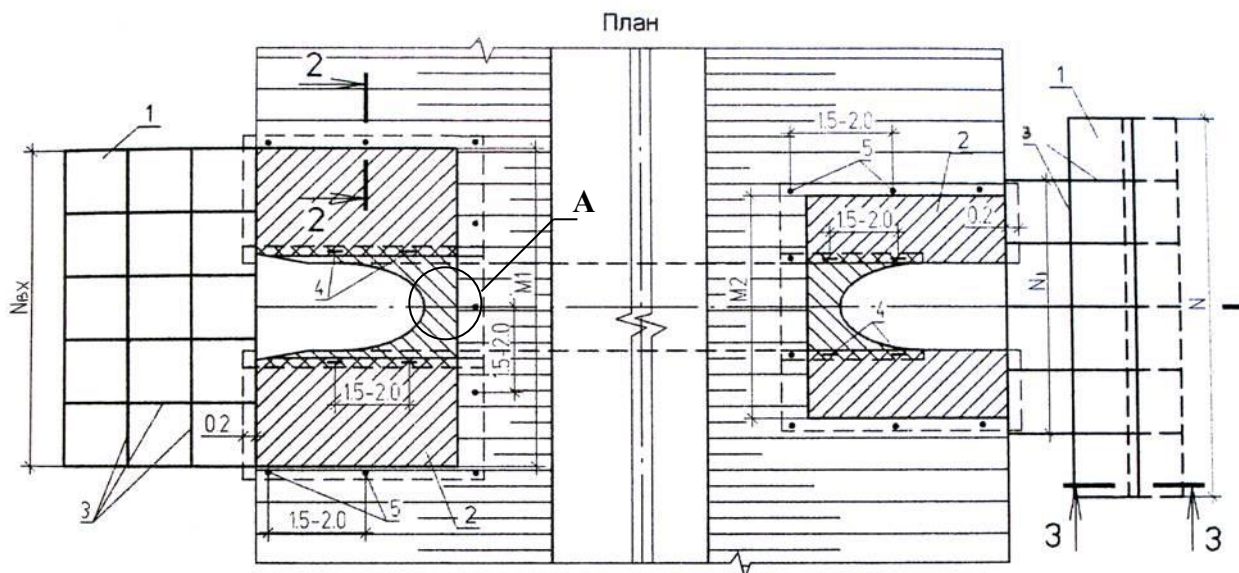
Схема плана трубы при укреплении откосов нетканым синтетическим материалом русла плитами ПК 100.12.е: 1- плиты ПК100.12.е; 2 – НГ СТ; 3 - строительный раствор; 4 – скобы; 5 – кольца
